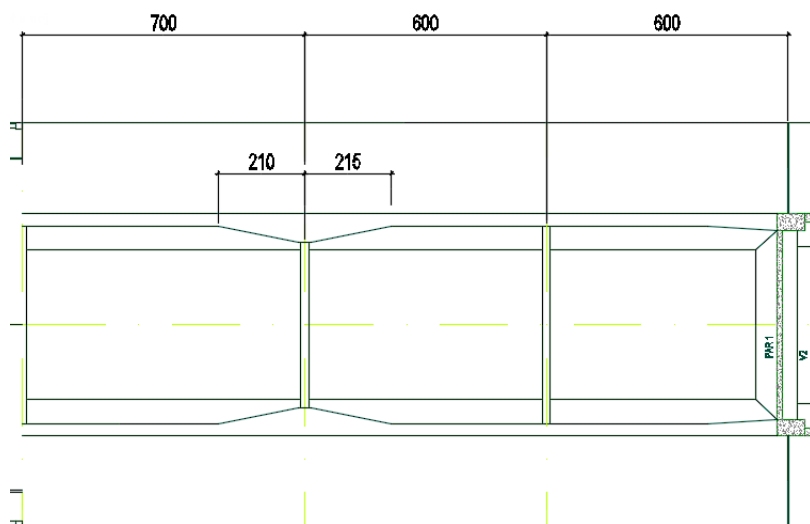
Planta de forma da ponte 1 (dimensões em cm)
